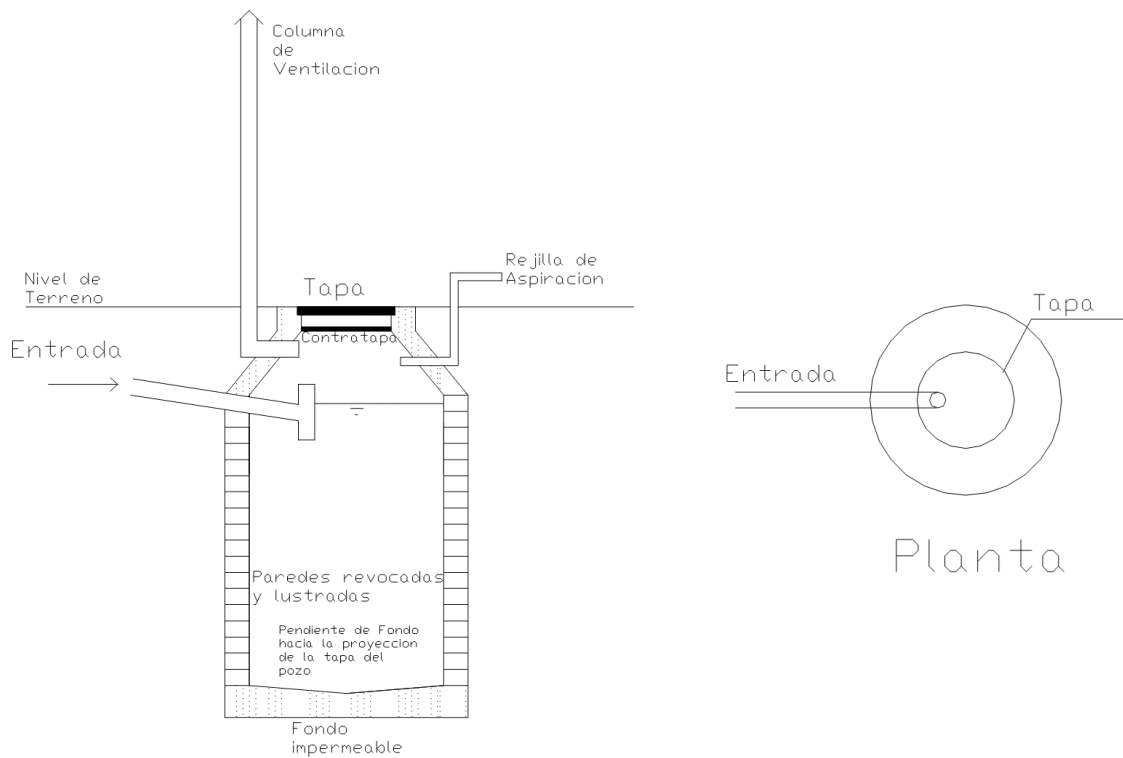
Planta y corte esquemáticos de un depósito fijo impermeable
